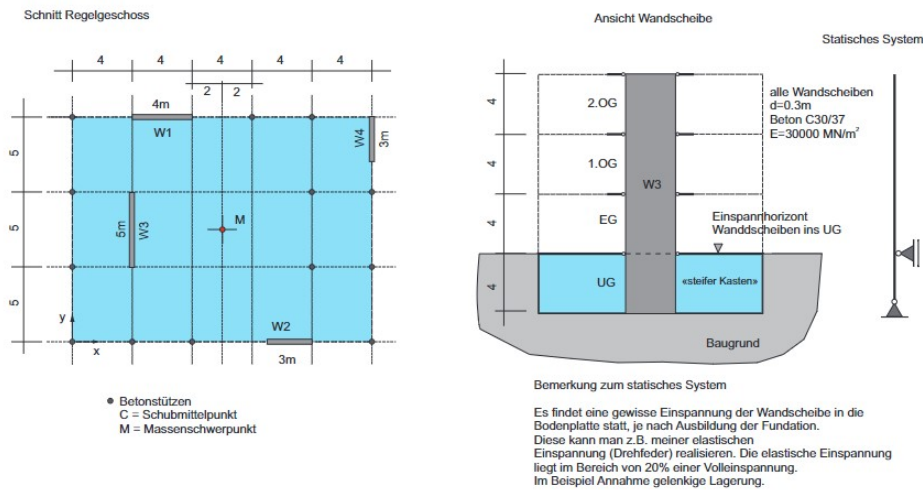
Grundriss und Schnitt des Gebäudes mit dem entsprechenden statischen System
